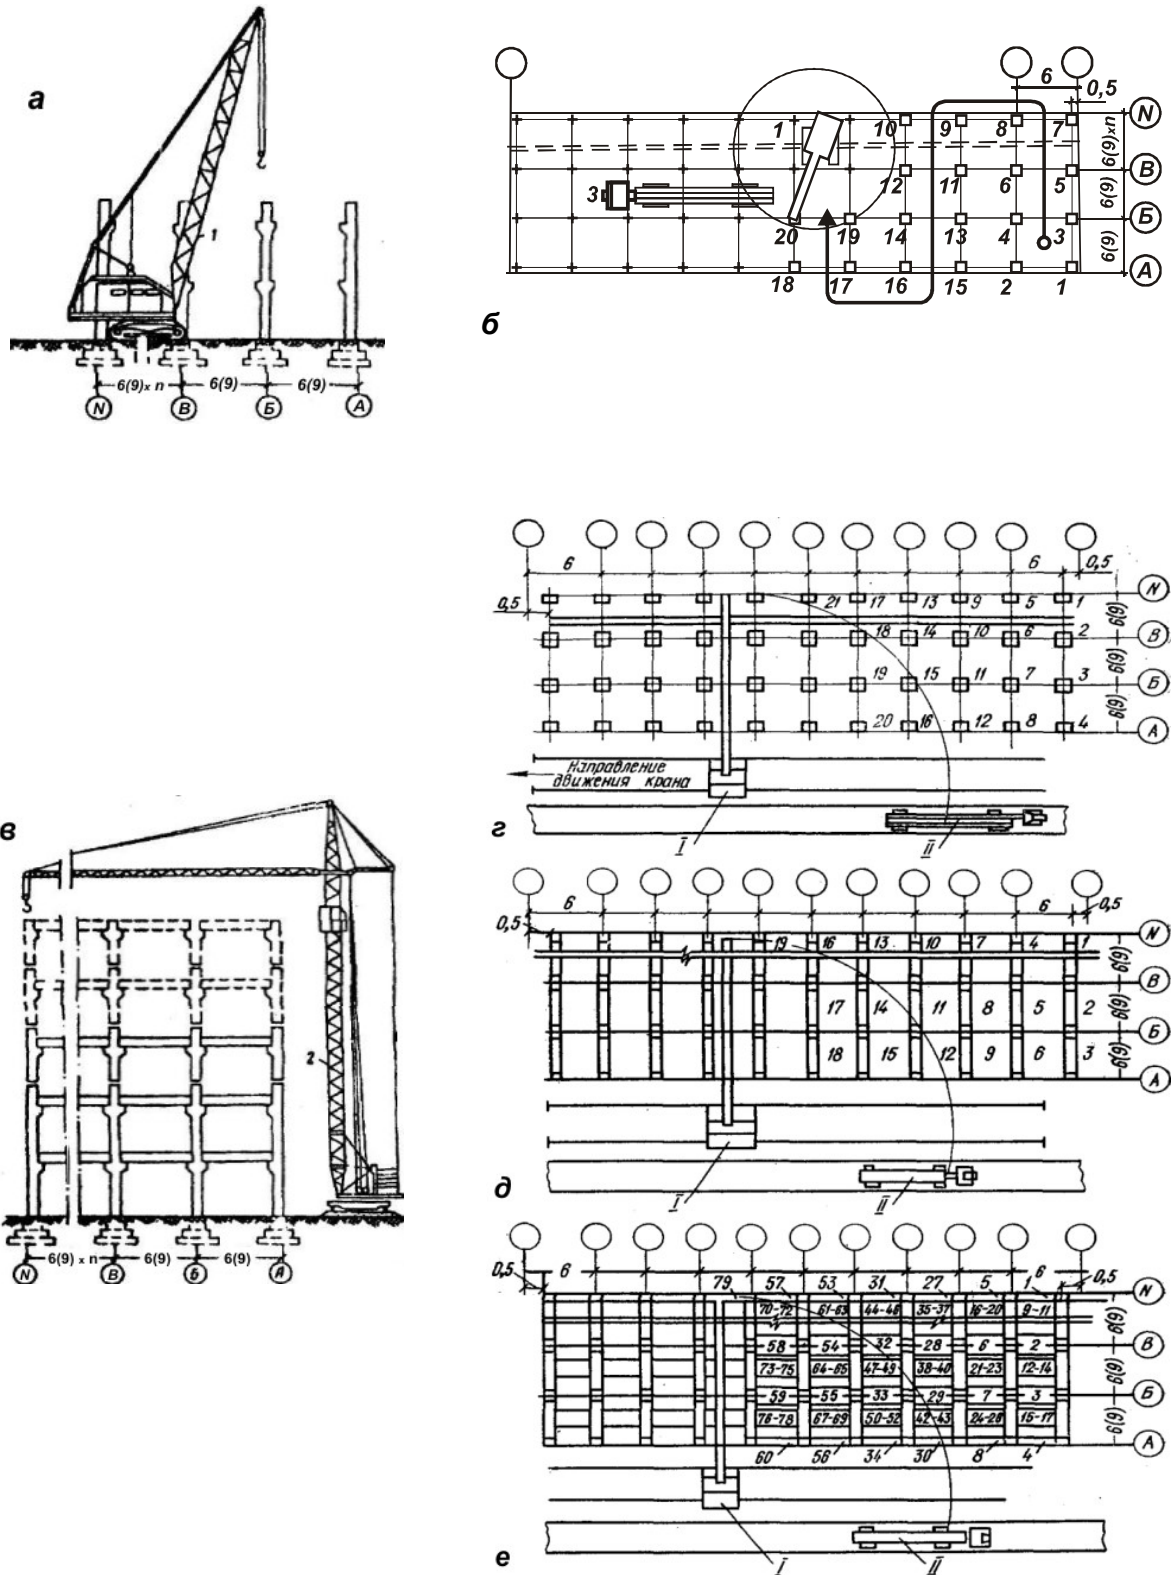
Схема монтажу багатоповерхової будівлі стріловим та баштовим кранами: а - схема розташування стрілового крана; б - монтаж колон нижнього ярусу; в - схема розташування баштового крана; г - монтаж колон наступних ярусів; д - монтаж ригелів; е - монтаж плит перекриття; 1 - стріловий кран; 2 - баштовий кран; 3 - транспортний засіб.
